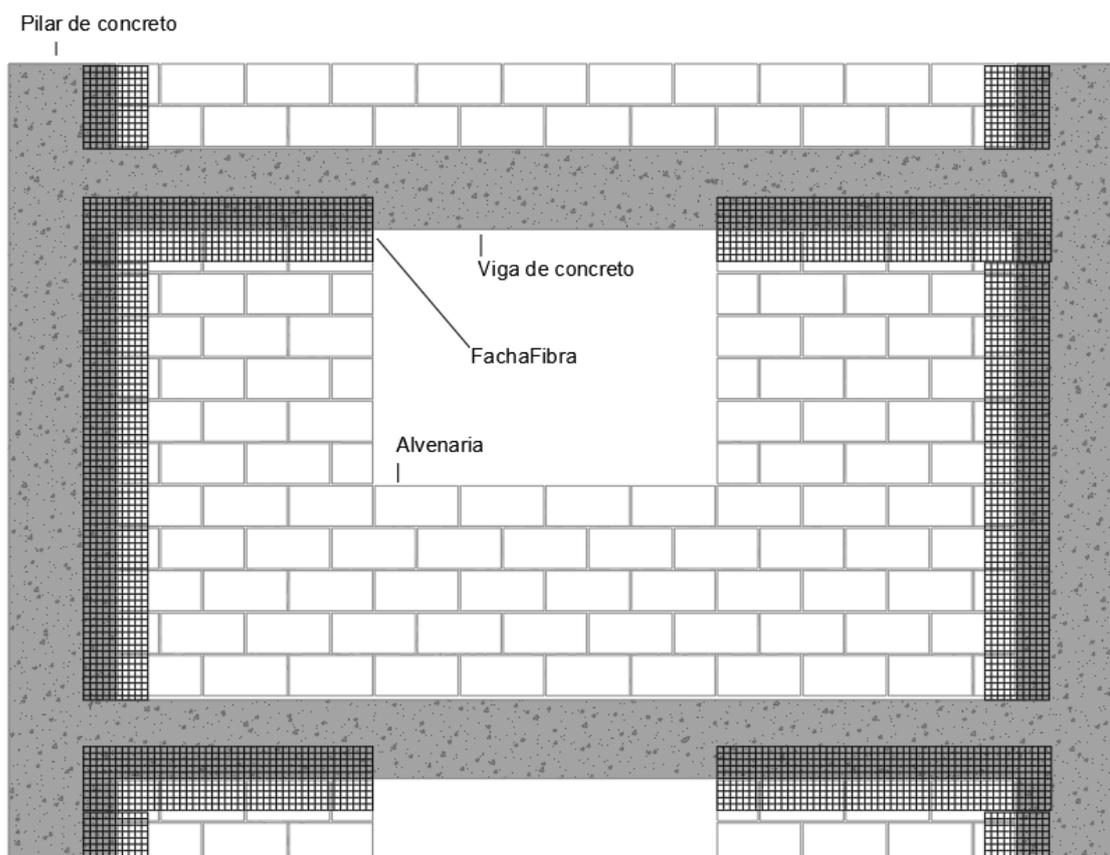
Posicionamento da FachaFibra para reforço do revestimento de argamassa nas interfaces entre alvenaria de vedação e estrutura de concreto armado (vigas e pilares)
